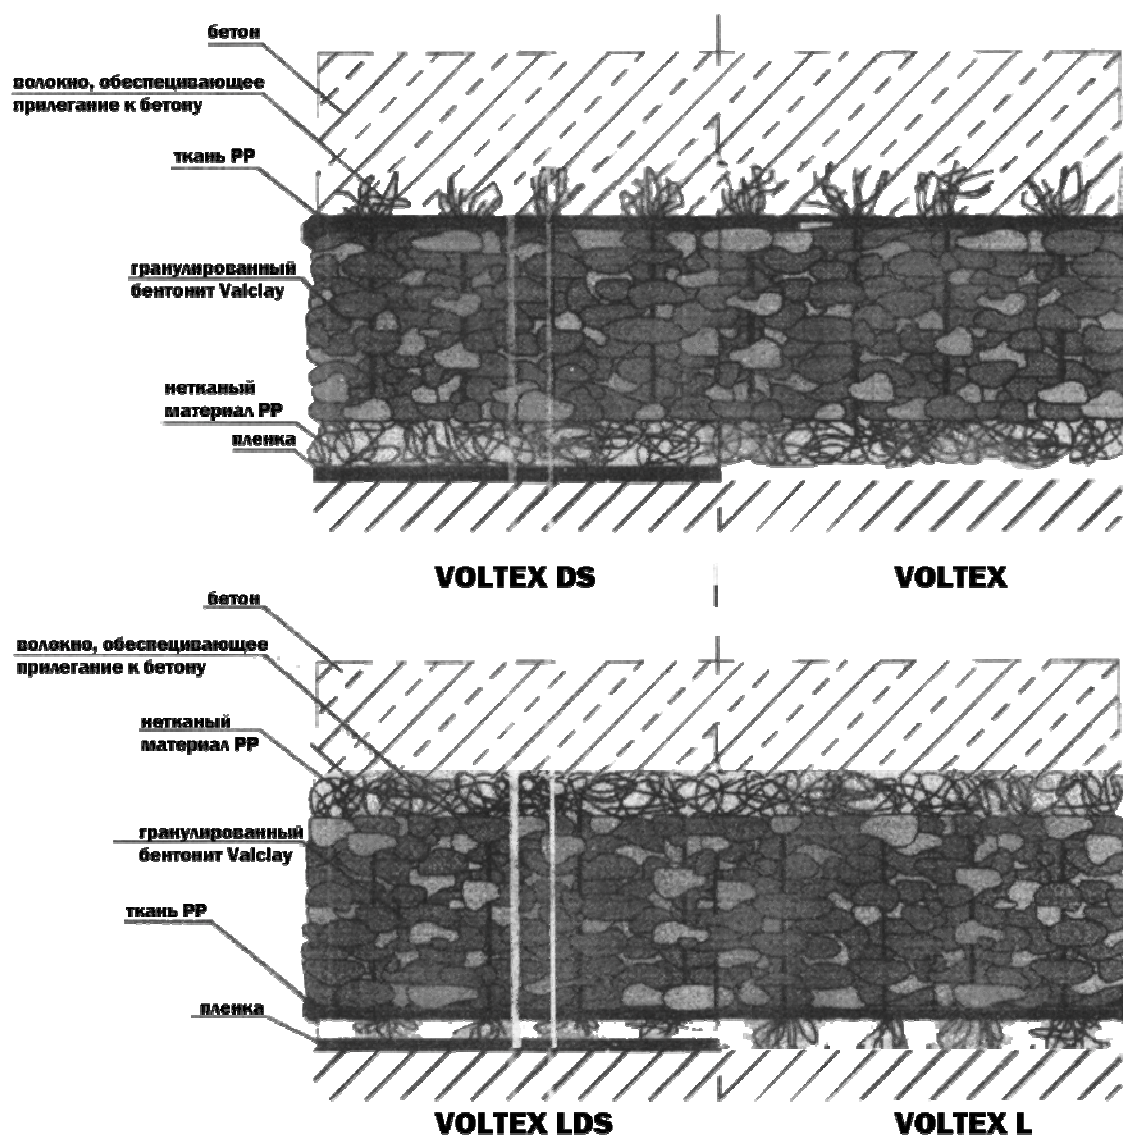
Поперечное сечение бентонитового мата, защищаемой конструкции и грунта
